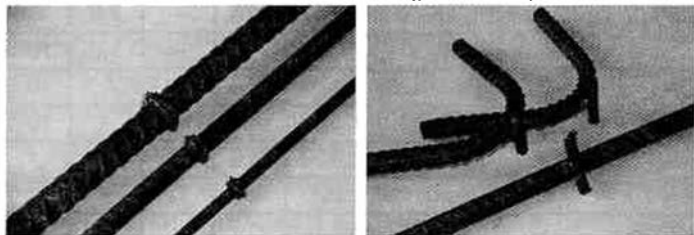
Сварные соединения арматурного проката класса Ан600С
